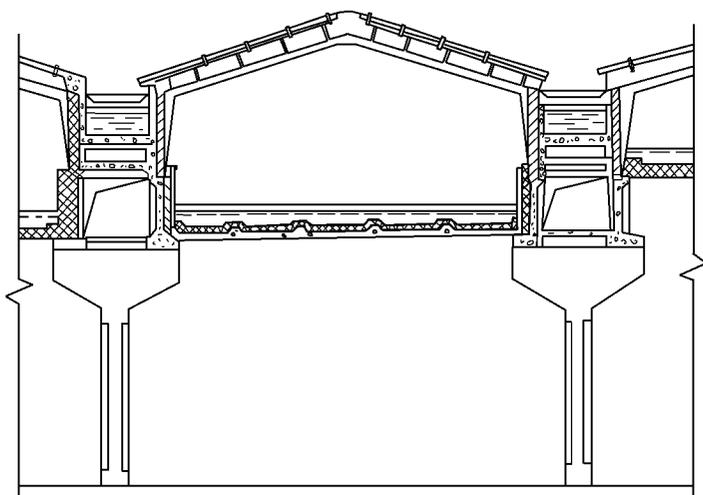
带有技术夹层的钢筋混凝土结构无窗厂房
